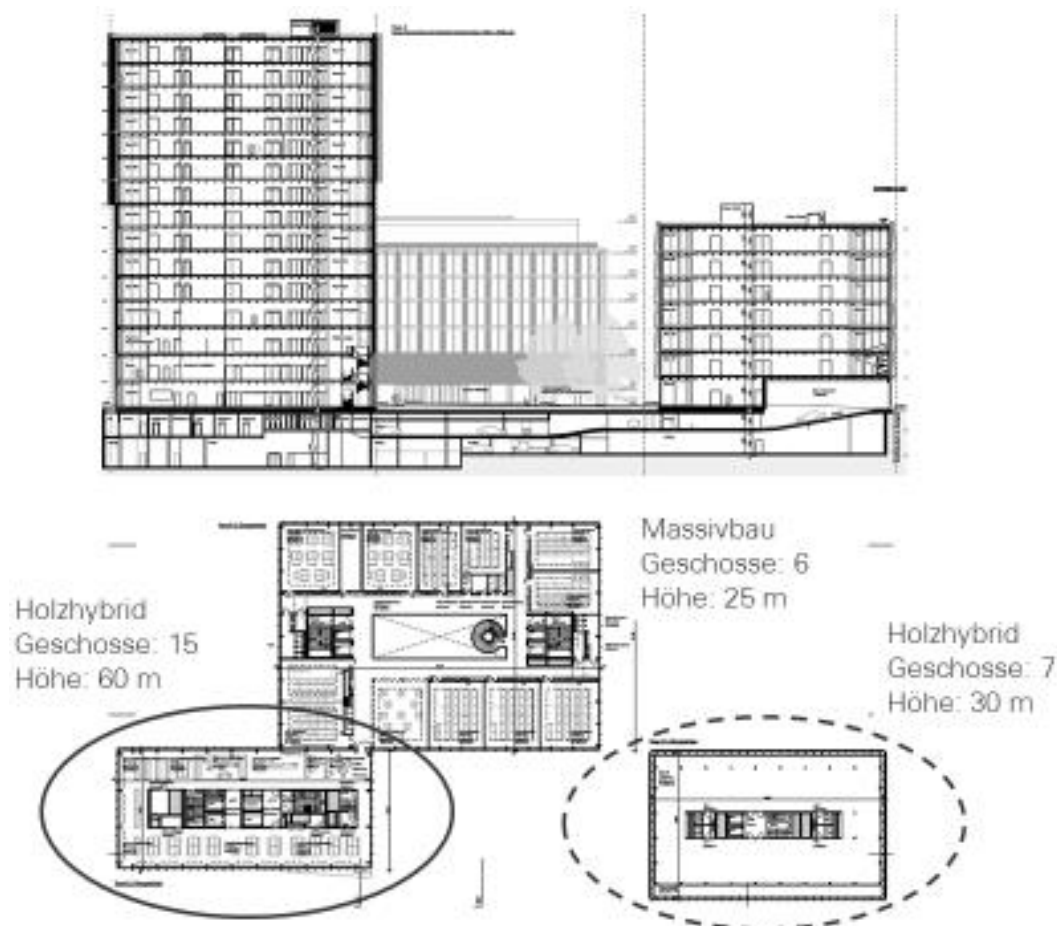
Längsschnitt und Grundriss durch die Überbauung
